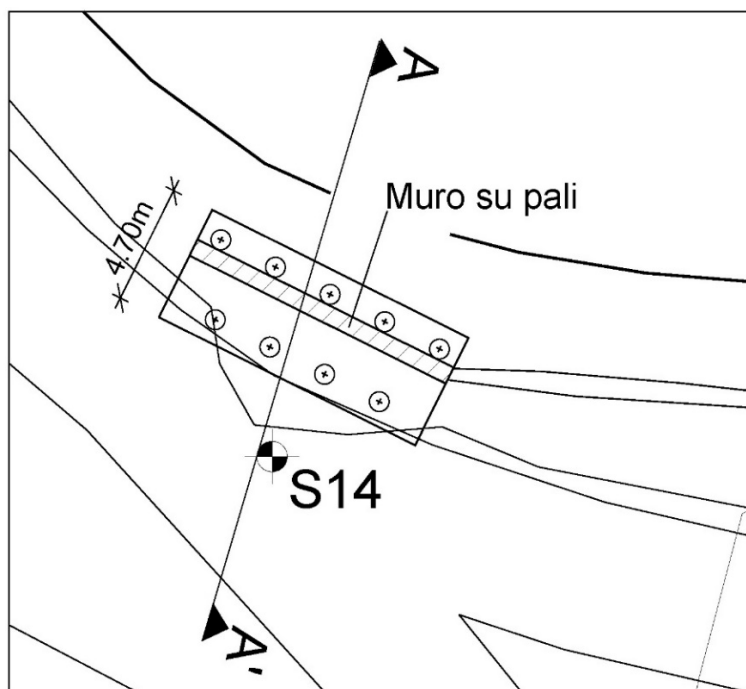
Zona Pietralunga, km 8+700. Planimetria schematica con indicazione del muro su pali.
